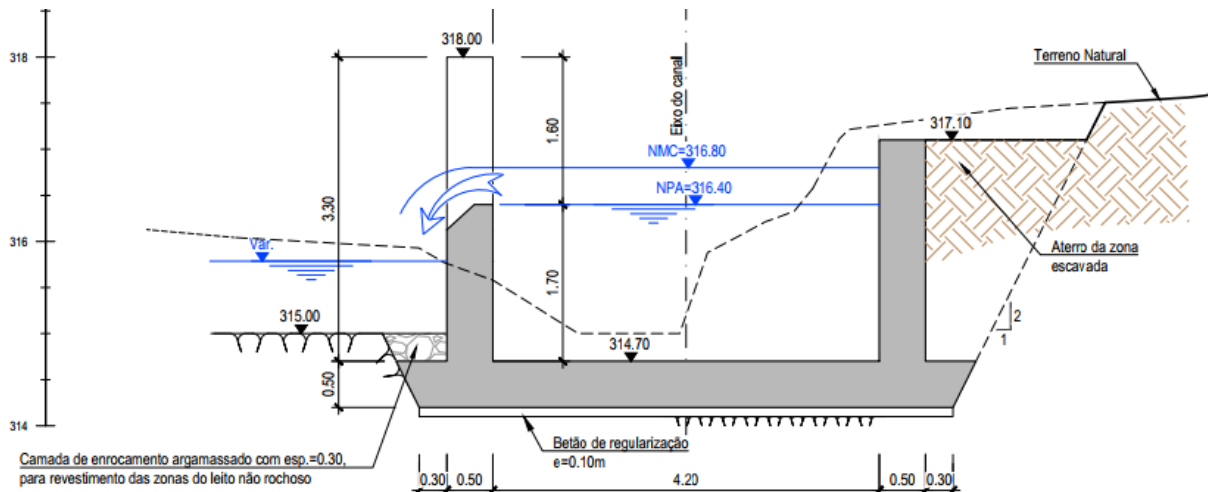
Corte transversal indicativo da soleira descarregadora de betão
